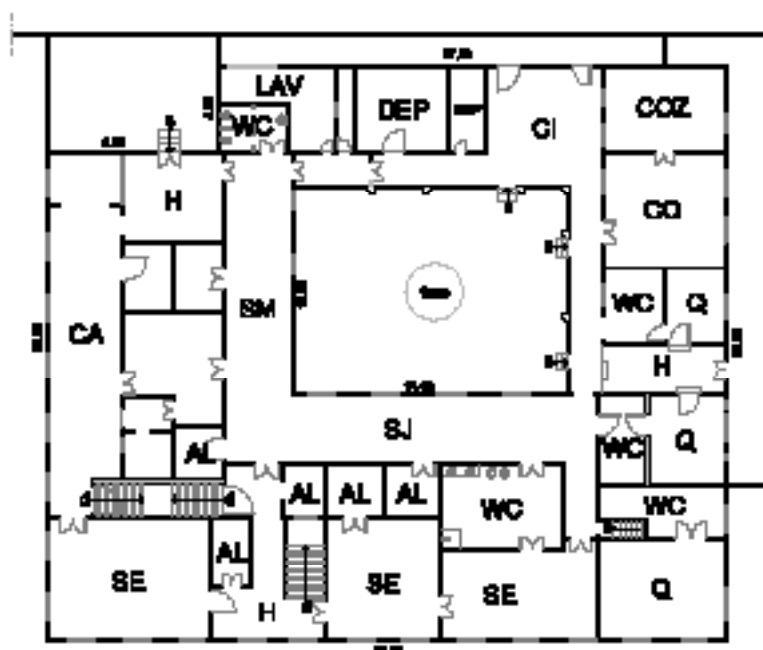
Planta baixa de 0000 - 1980 escala 1/100
